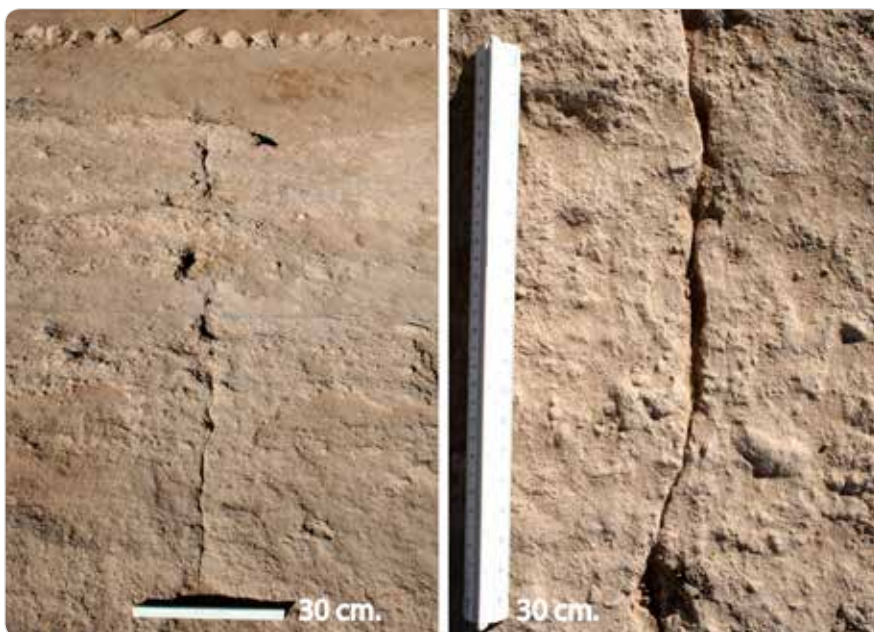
Junta transversal de unión del mortero de cal de la capa de rodadura.
